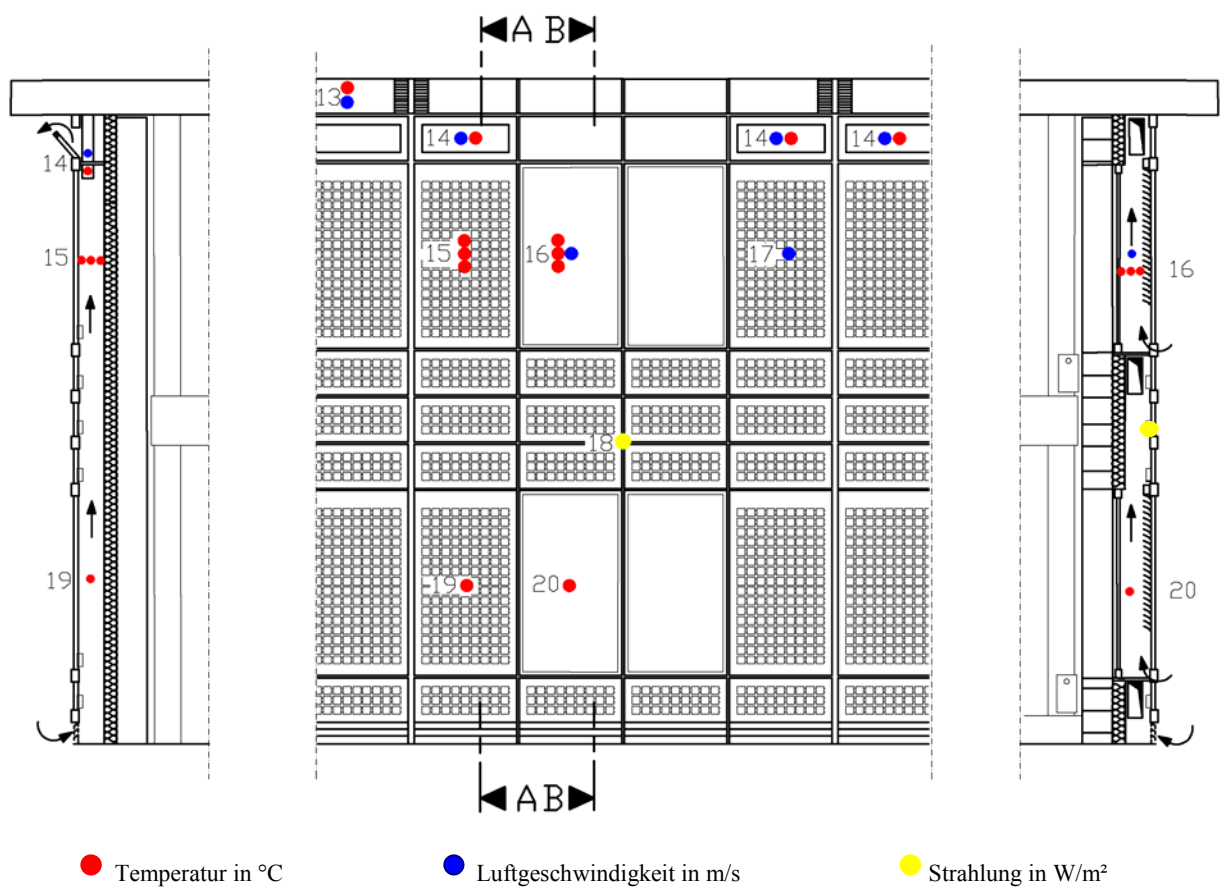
Teilbereich der Doppelfassade (Schnitt A - A: Vertikalschacht und Schnitt B - B: Fensterkastenschacht) mit Lage der Meßfühler (lfd. Nr. 13-20).
